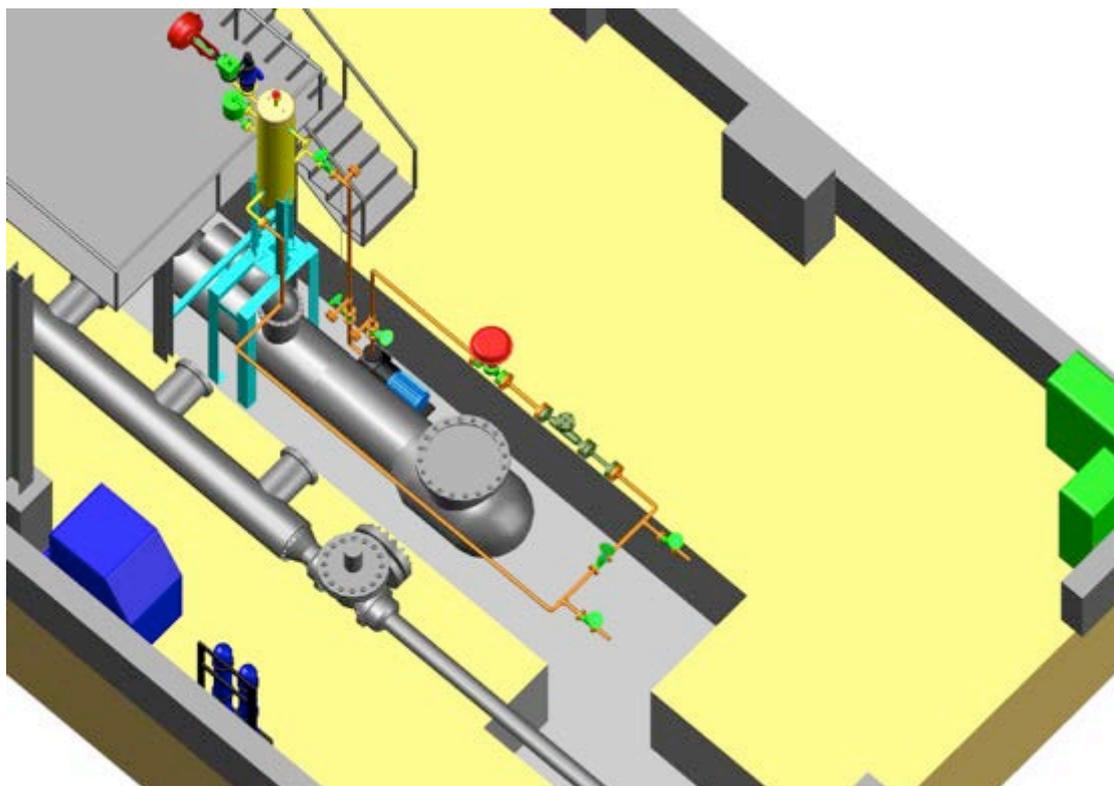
Vista in pianta dell’impianto SWINGER.
